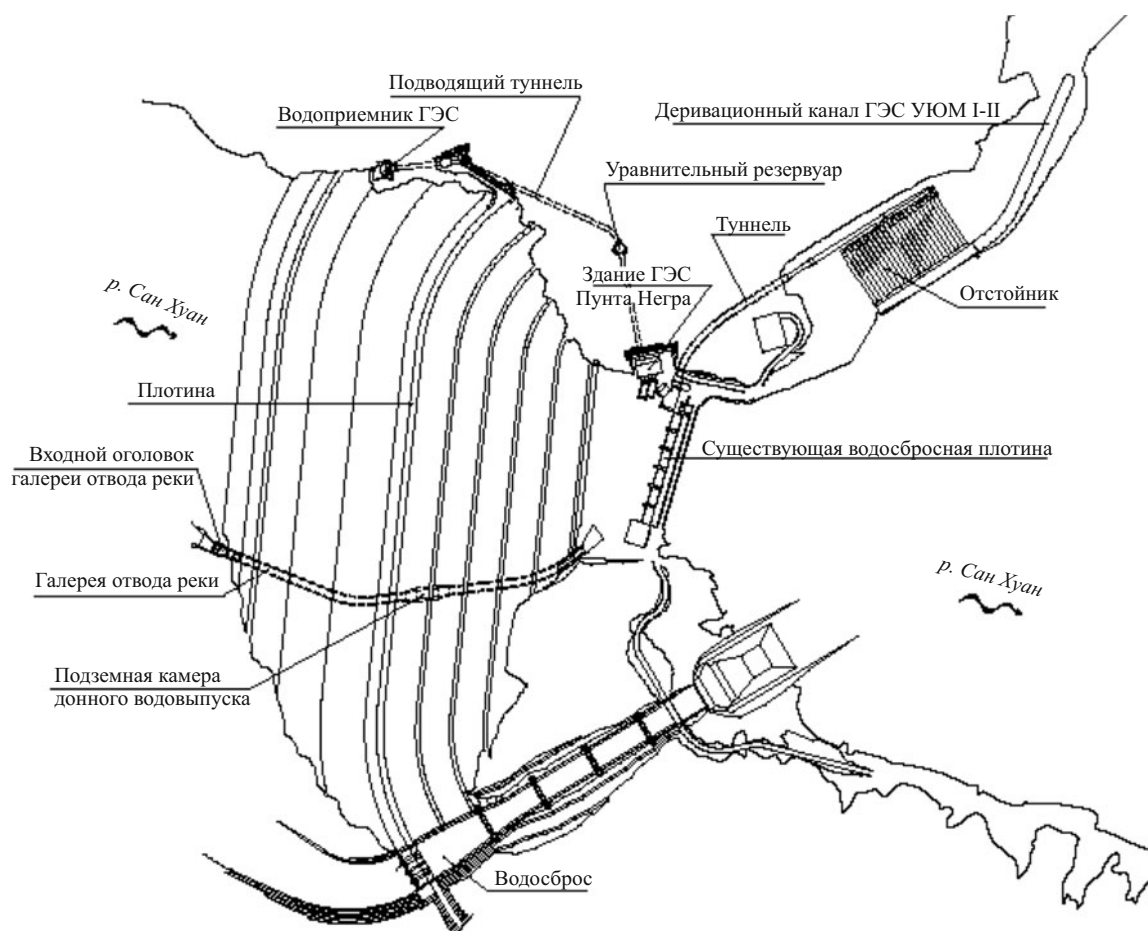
План гидроузла ГЭС Пунта-Негра, базовый проект
